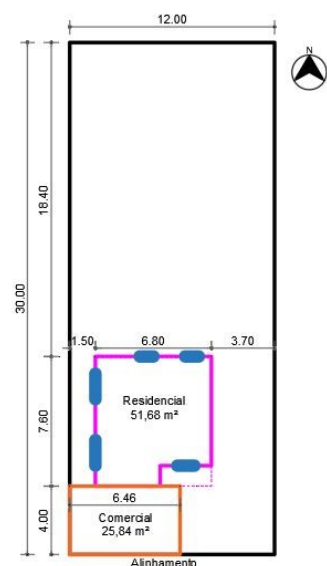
Croqui demonstrativo do projeto de localização – 01(um) pavimento – LEGALIZAÇÃO (Projeto B)
